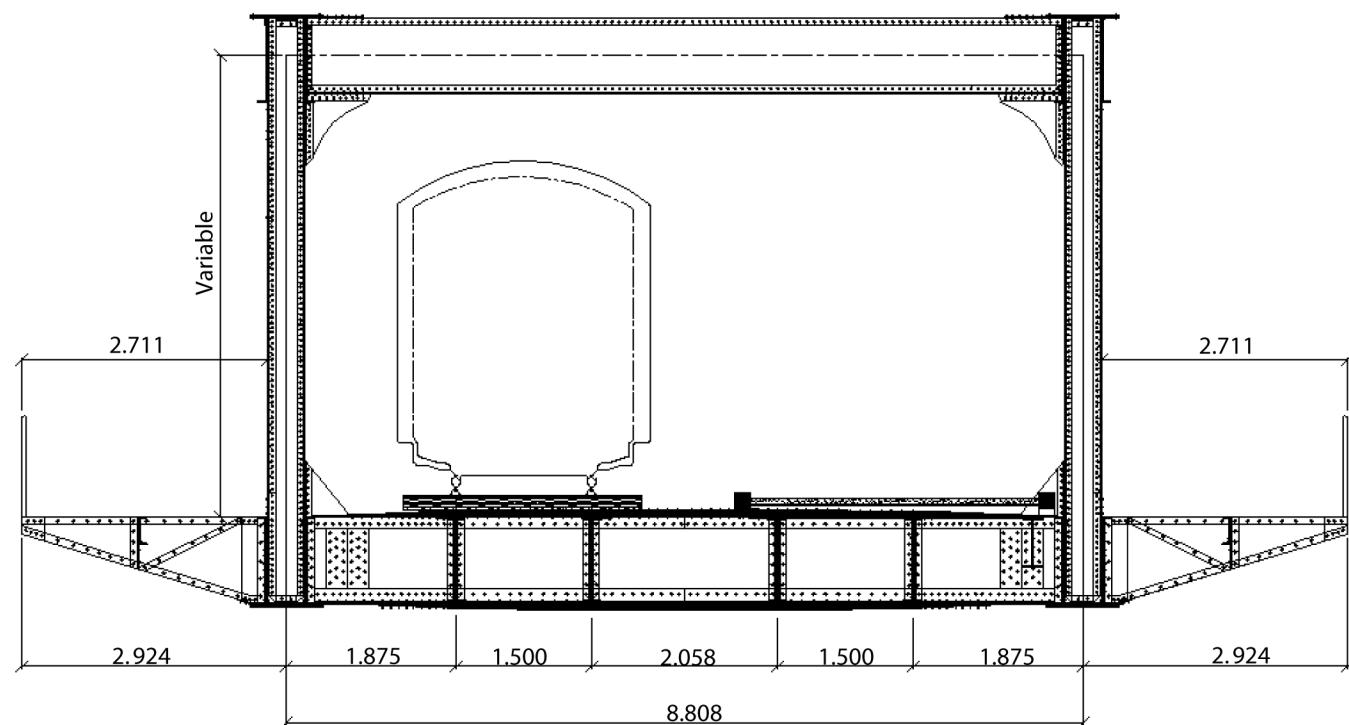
c : Coupe transversale du pont-rails de Zifta.
